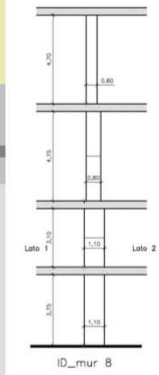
Schema planimetrico per l'individuazione dei maschi murari
